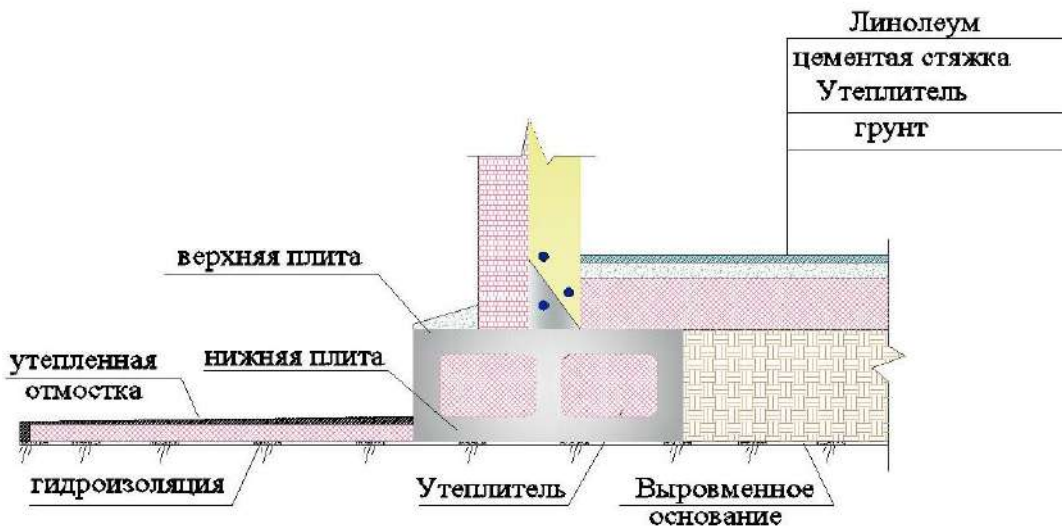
Ленточный плитно-рамный фундамент. Поперечное сечение
